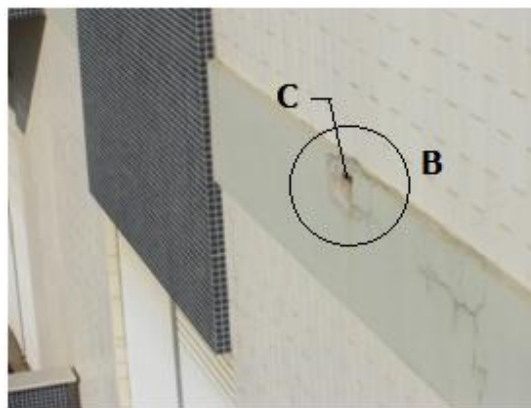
Delaminação do betão e armadura à vista “B; C”
